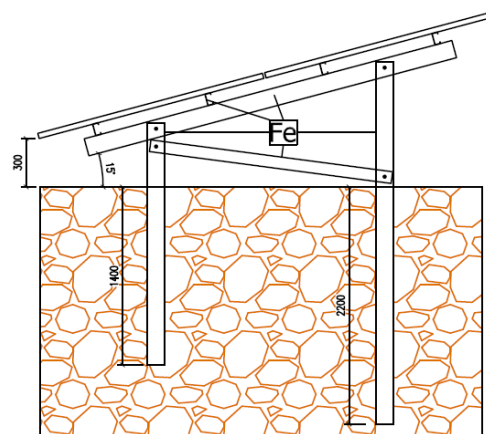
Vista perfil de la estructura. Detalle del hincado. Fuente: Ficha técnica de la estructura, Sunfer
